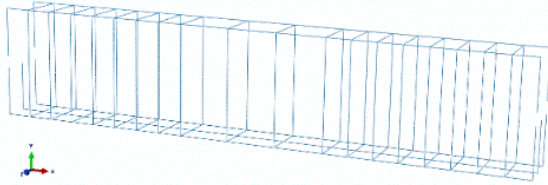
Betonarme kısa kiriş detayı (boyutlar mm).
